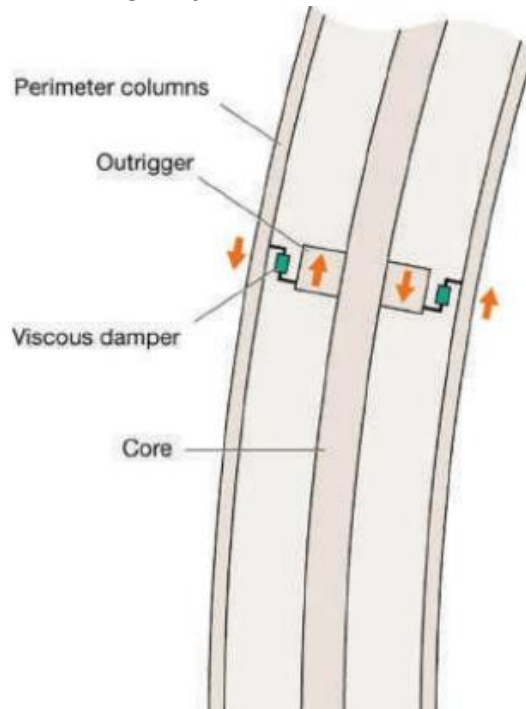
Amortiguadores en sistema estabilizante (*Outrigger Systems*) [35].
